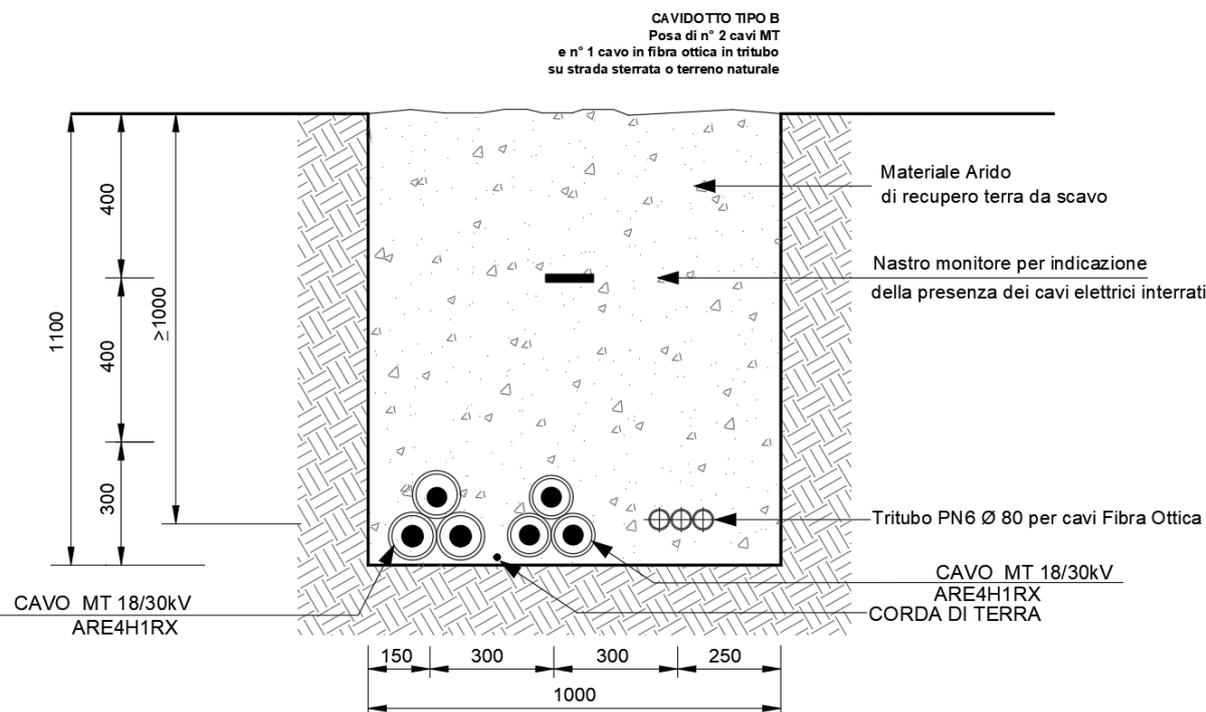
Sezione tipo posa cavi MT a 30 kV
